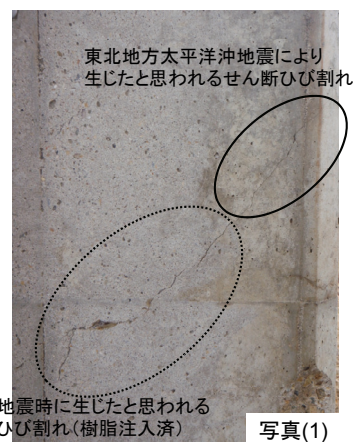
第 5 猪鼻高架橋の損傷の様子 (R12 と R13)
